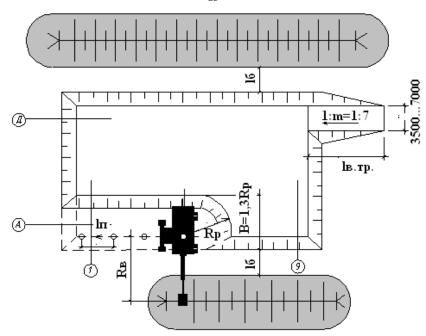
Схемы боковых проходок при устройстве котлована с разработкой грунта навымет
